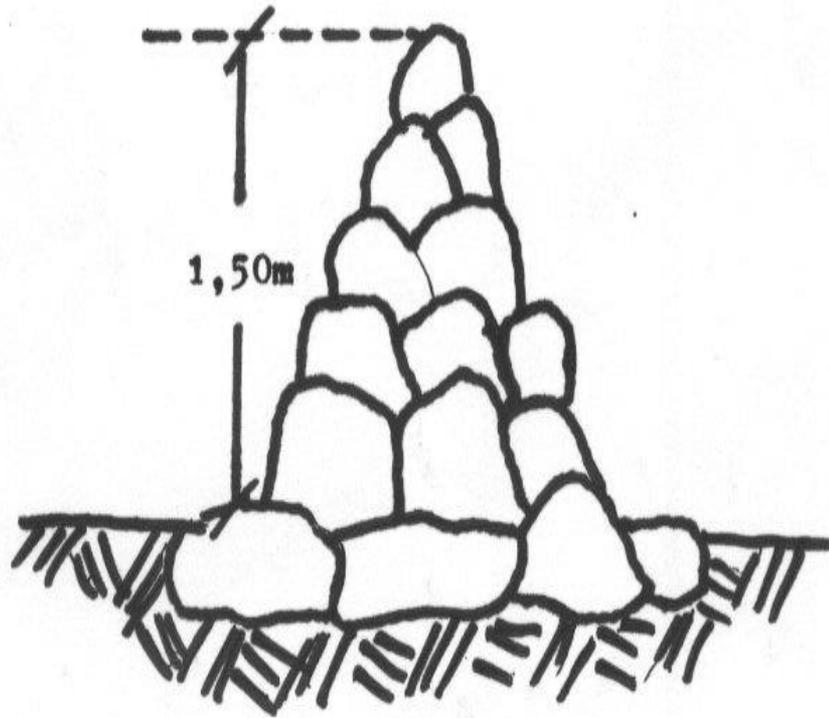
CORTE TRANSVERSAL DO MURO DE PEDRA
